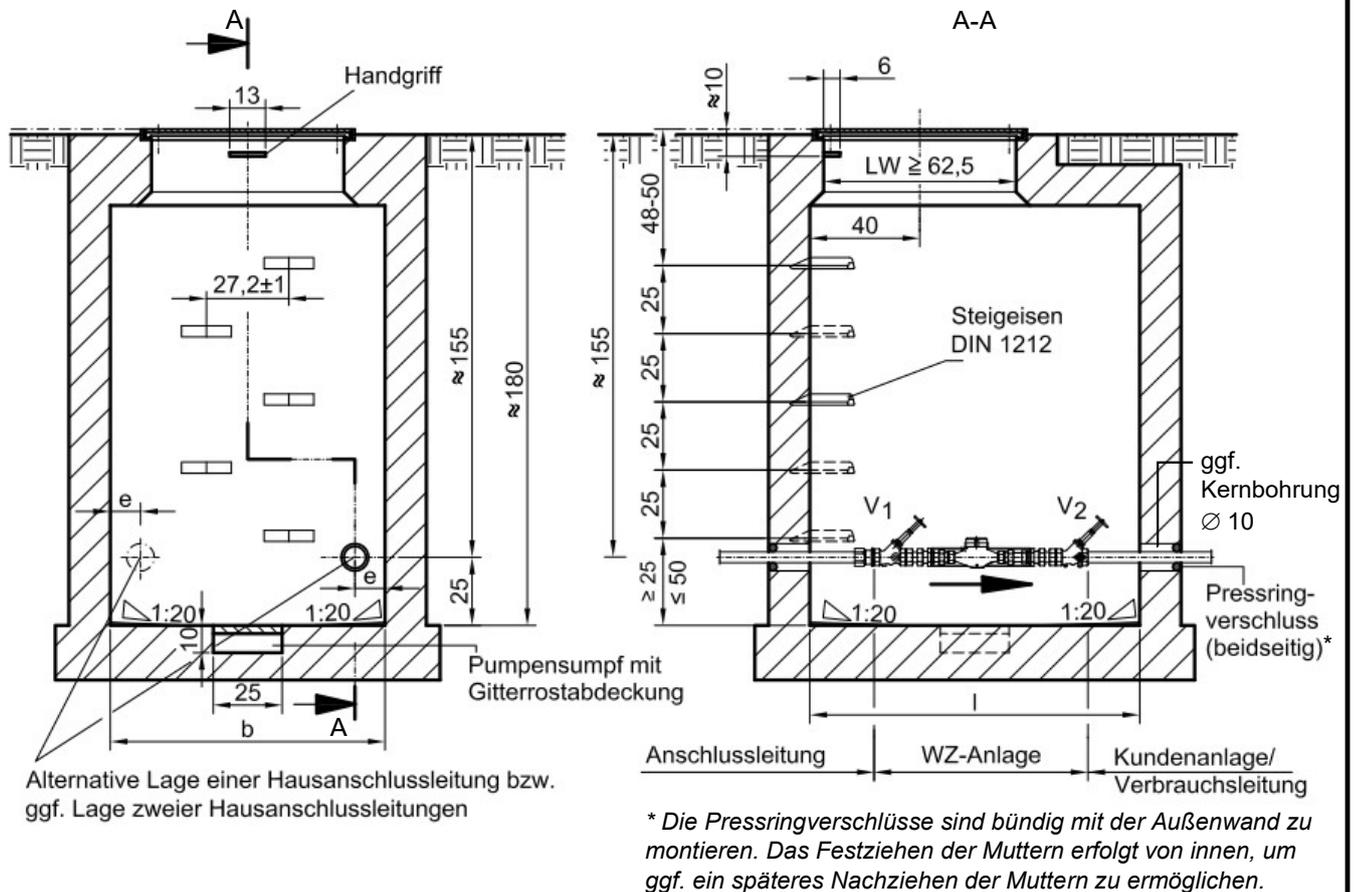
Wasserzählerschacht rechteckig, aus Beton bzw. Stahlbeton
